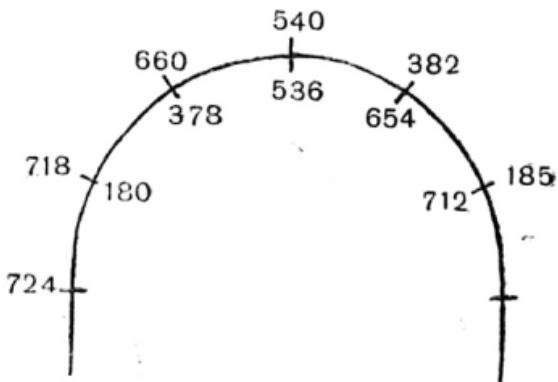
Расстановка размеров на черновой зарисовке обмера арки по способу П. Покрышкина
